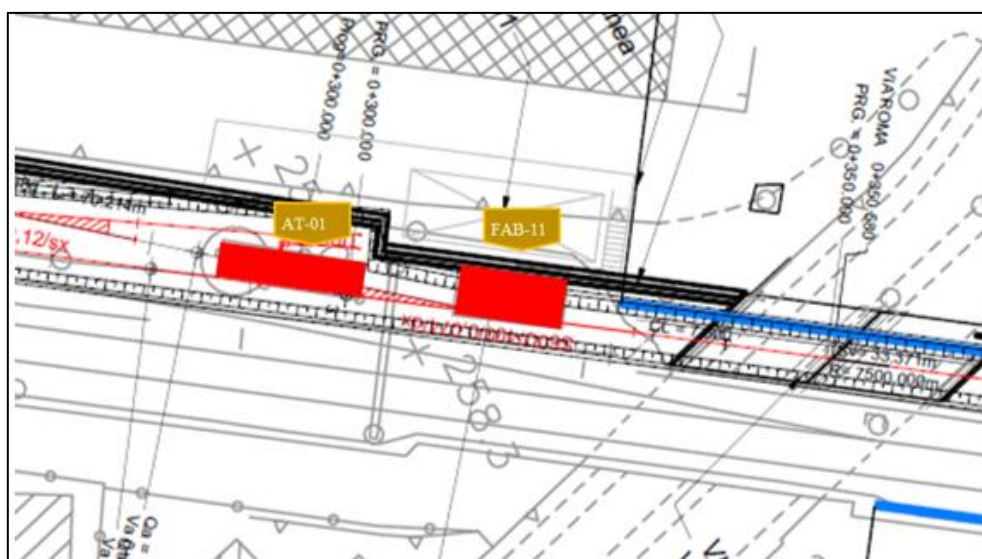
Stralcio planimetrico zona sottopasso via Roma
